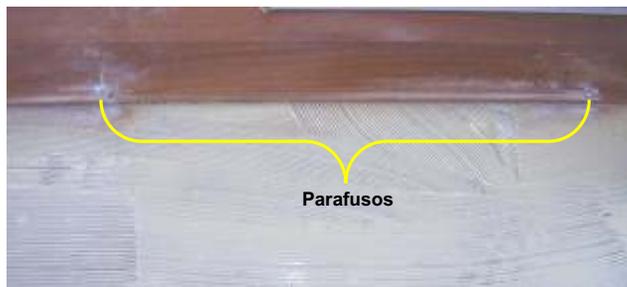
Montagem e fixação do piso de madeira utilizando adesivo e parafuso.
